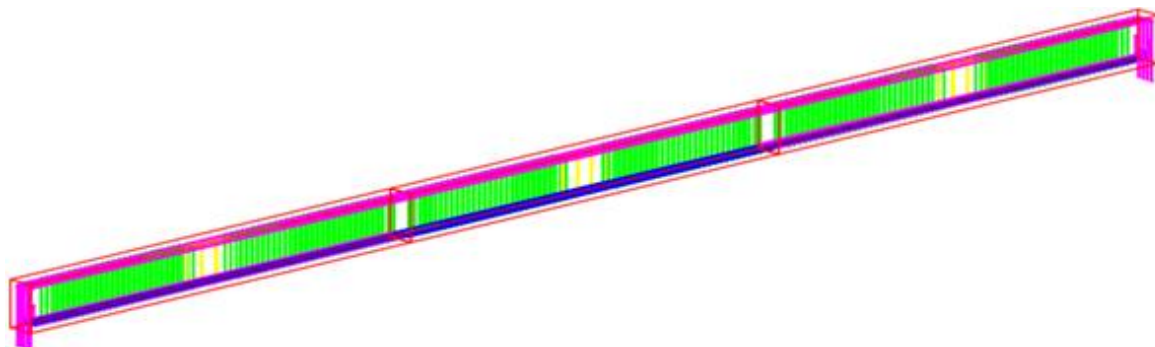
Desenho de viga completa barras (5, 6 e 7).
